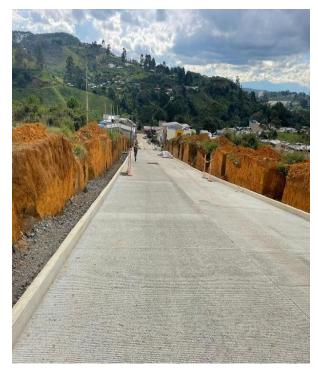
Losa de Concreto Terminada. Tomada in situ.
